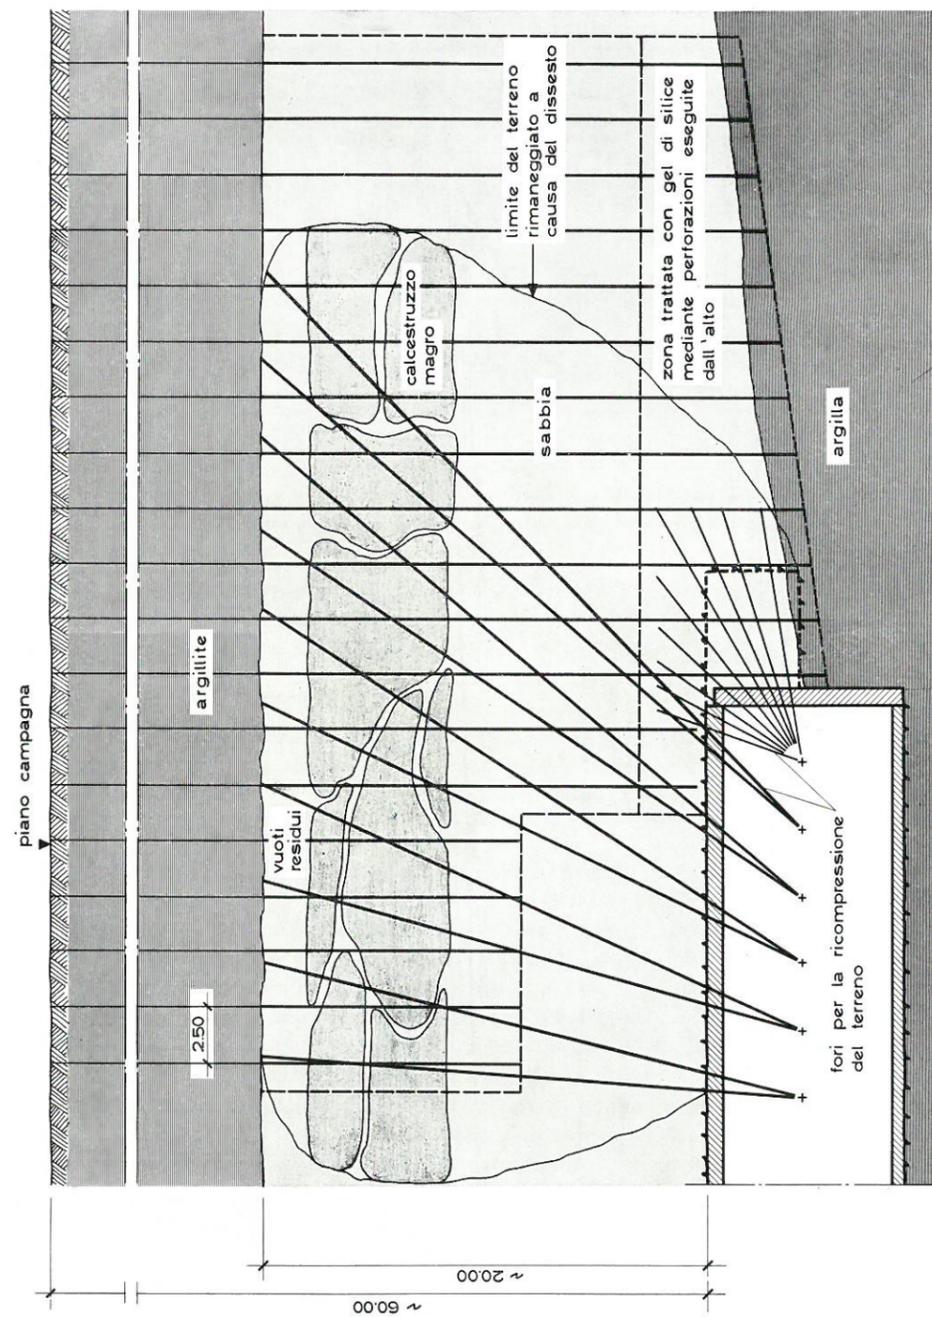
Galleria Cisterna - Rappresentazione di terreni e della situazione originata dal dissesto. Schema dei trattamenti di intasamento, di ricompressione e consolidamento.
